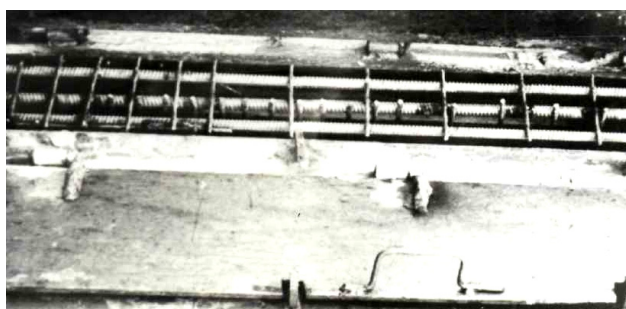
Опалубка с арматурными каркасами перед бетонированием
